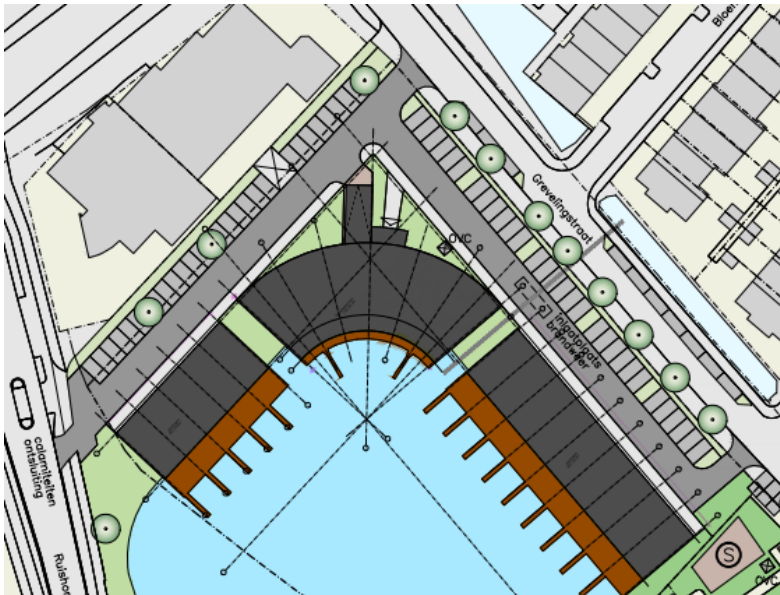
Situatie 28-03-2013 - inrit parkeergarage aan voorzijde appartementengebouw
